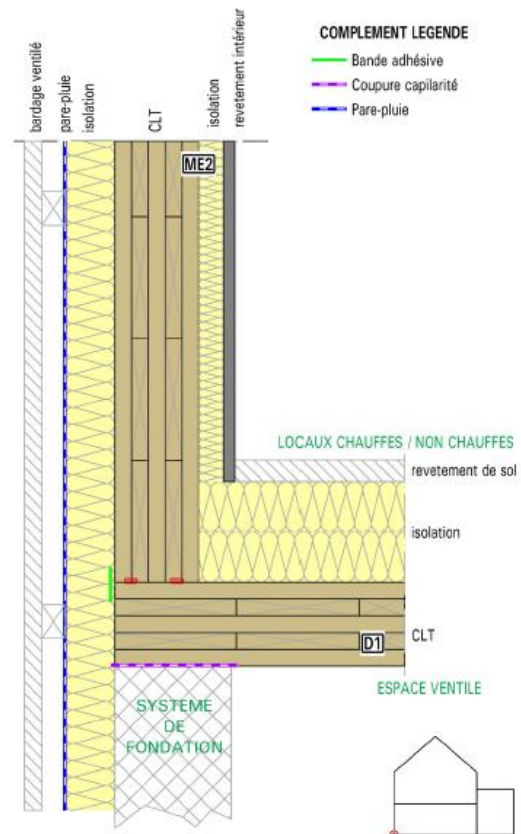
Liaison plancher bas sur vide sanitaire ou local non chauffé avec mur CLT et (ITE+ITI)
